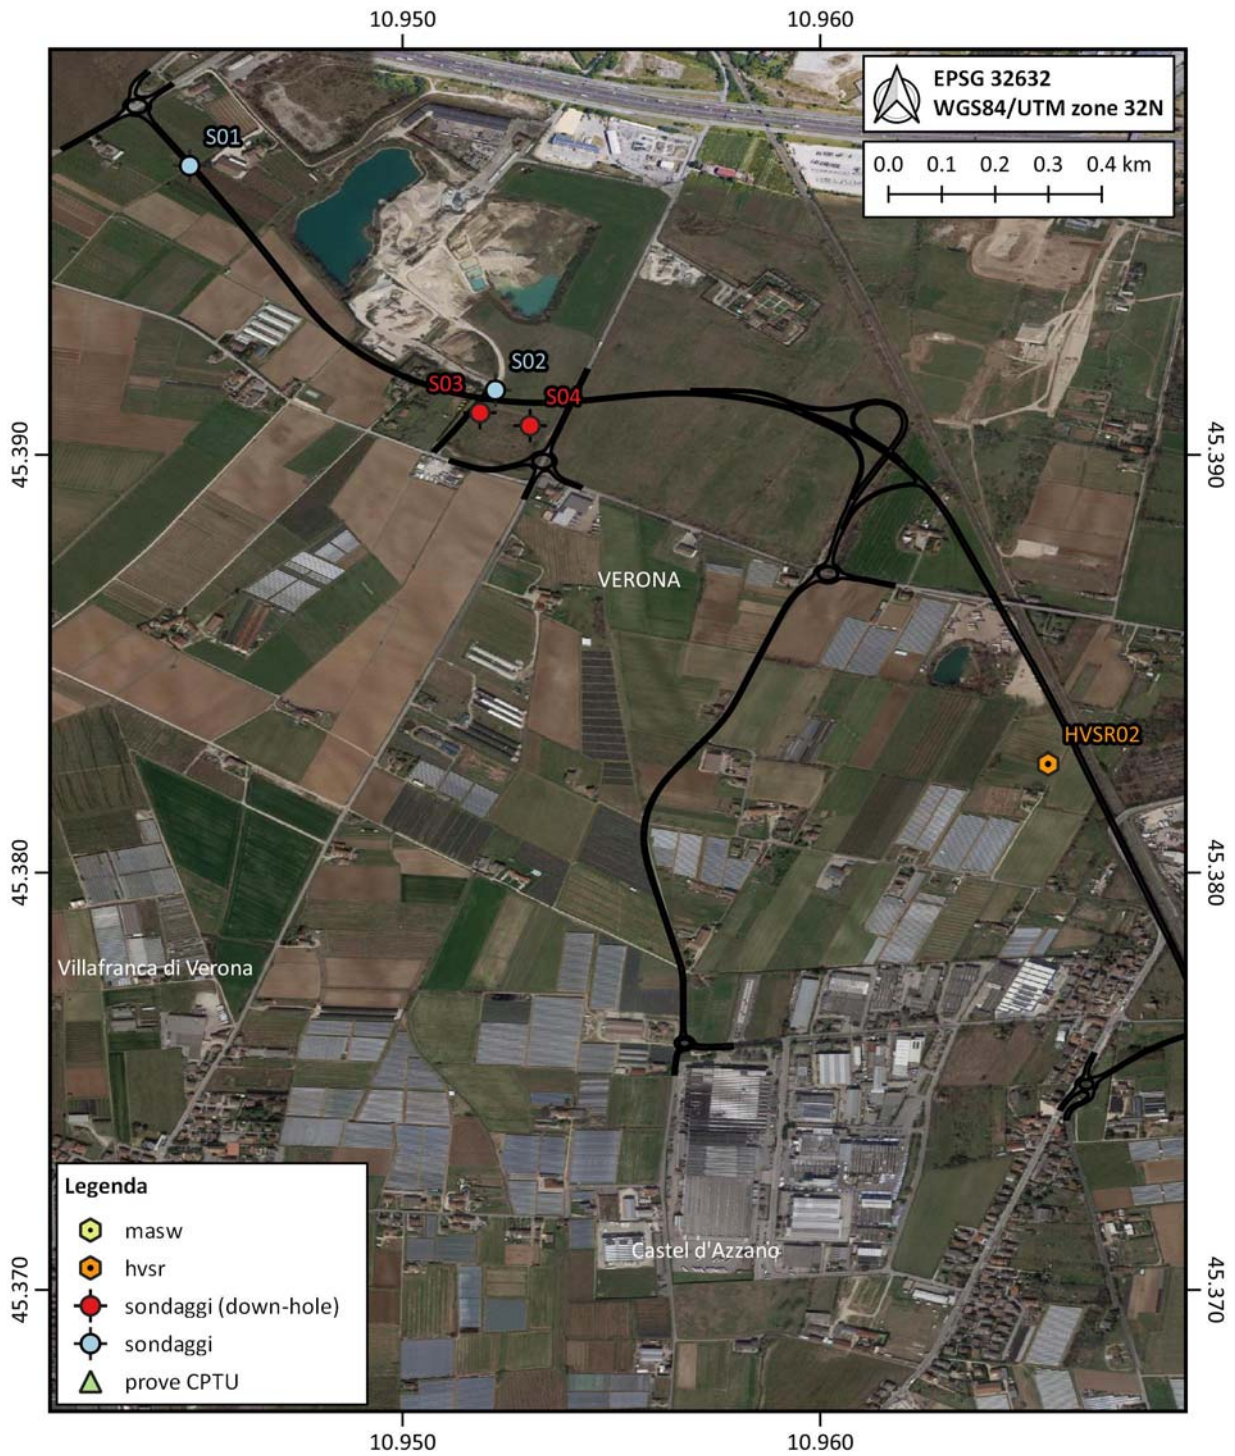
Planimetria con ubicazione delle indagini in sito svolte.
